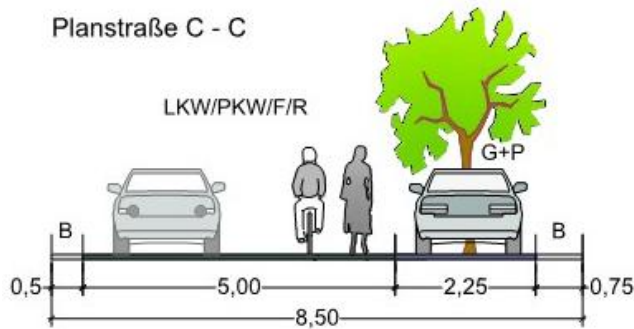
Straßenquerschnitt der Planstraße C, ohne Maßstab
